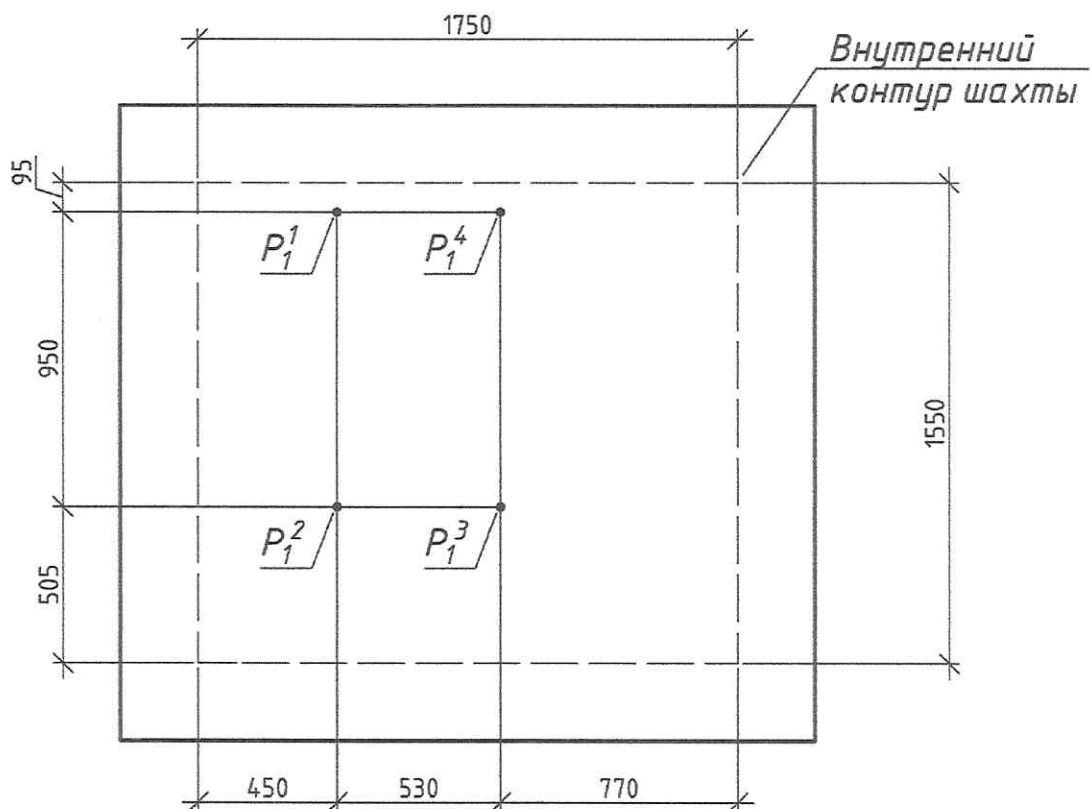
Нагрузки на плиту перекрытия шахты от лифтового оборудования.
